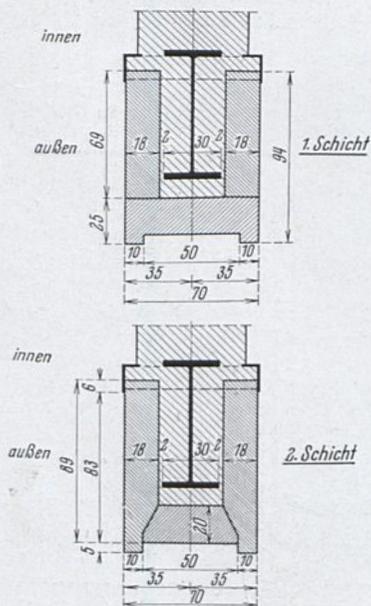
Werksteinverkleidung und Ausmauerung einer Zwischenstütze der Ehrenhalle.
